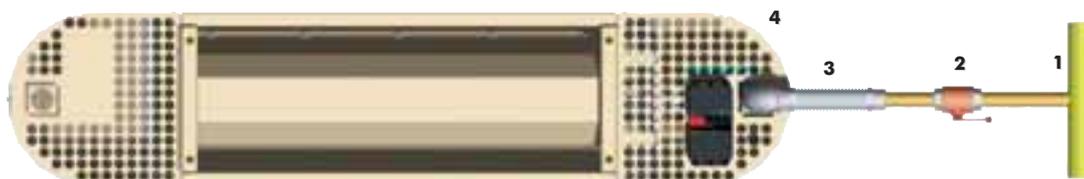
Схема подключения излучателя SUNRAD к газовой сети
